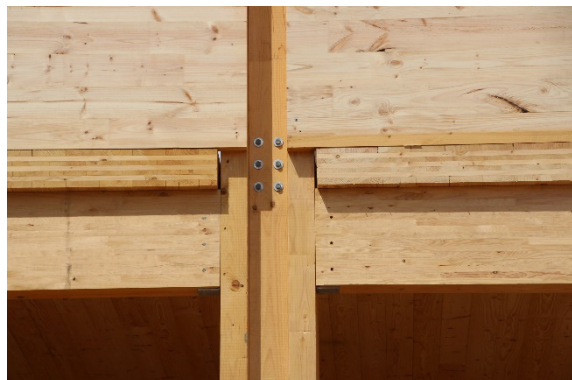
Detalle de unión entre pilares, viajes y forjados de CLT.
